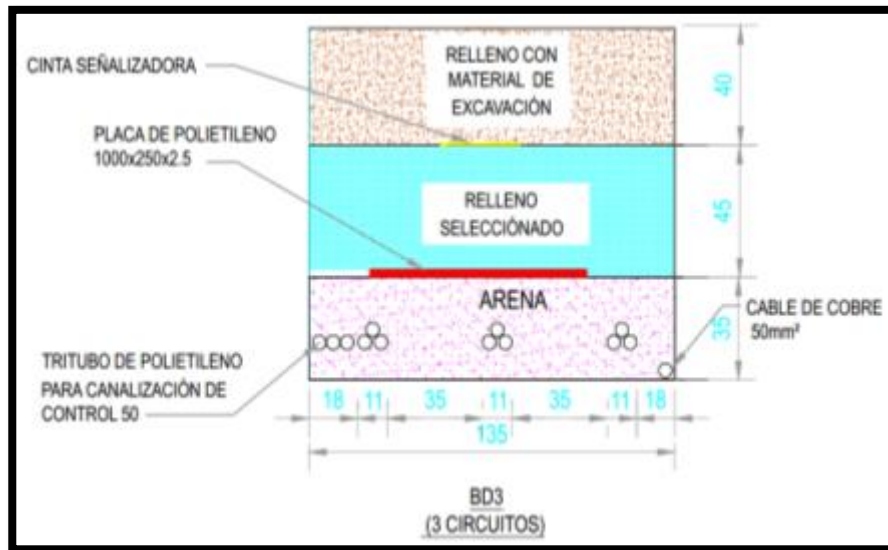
Disposición de cables de potencia en la Sección Zanja Tipo 3.
